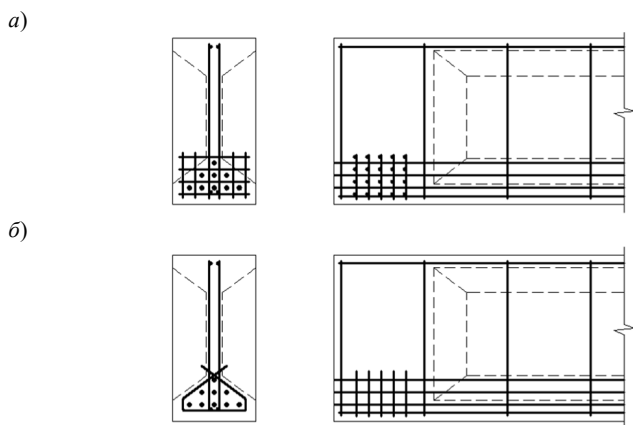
Схемы местного усиления концевых участков предварительно напряженных балок: *а* — поперечными сварными сетками; *б* — хомутами или сварной сеткой в обхват
